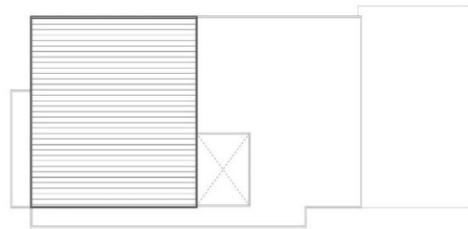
Planta Arquitectónica Primer Piso / Fuente: Elaboración propia
